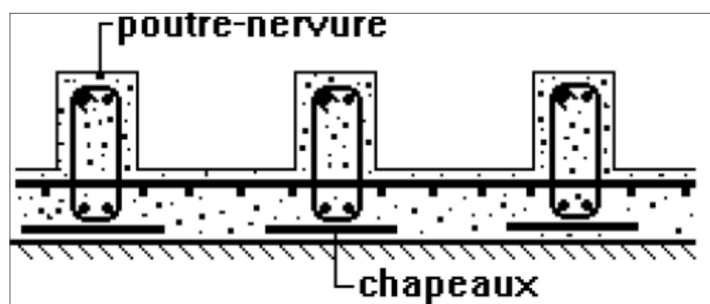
Coupe et Ferrailage d'un radier nervuré.
